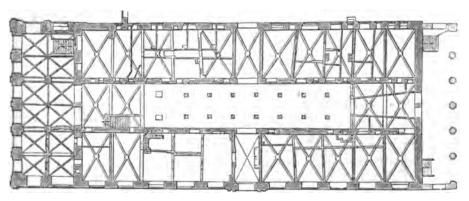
Rathhaus. Grundriss. 1:667.
